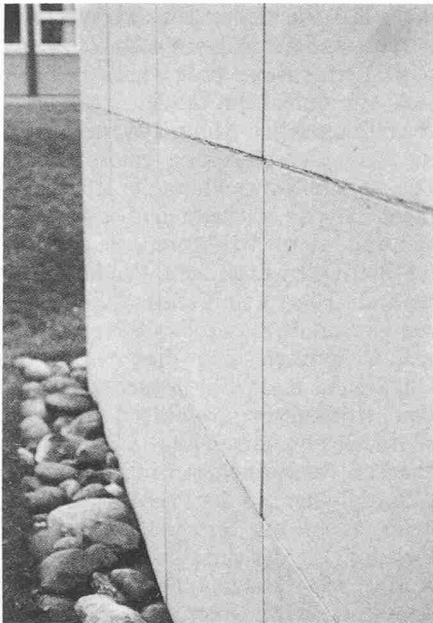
Pavillonanbau Spital Baden/ (Schweiz). Ge-wölbte Fassadenplatten durch nicht ausgereifte Be-festigungstechnik mitverursacht
